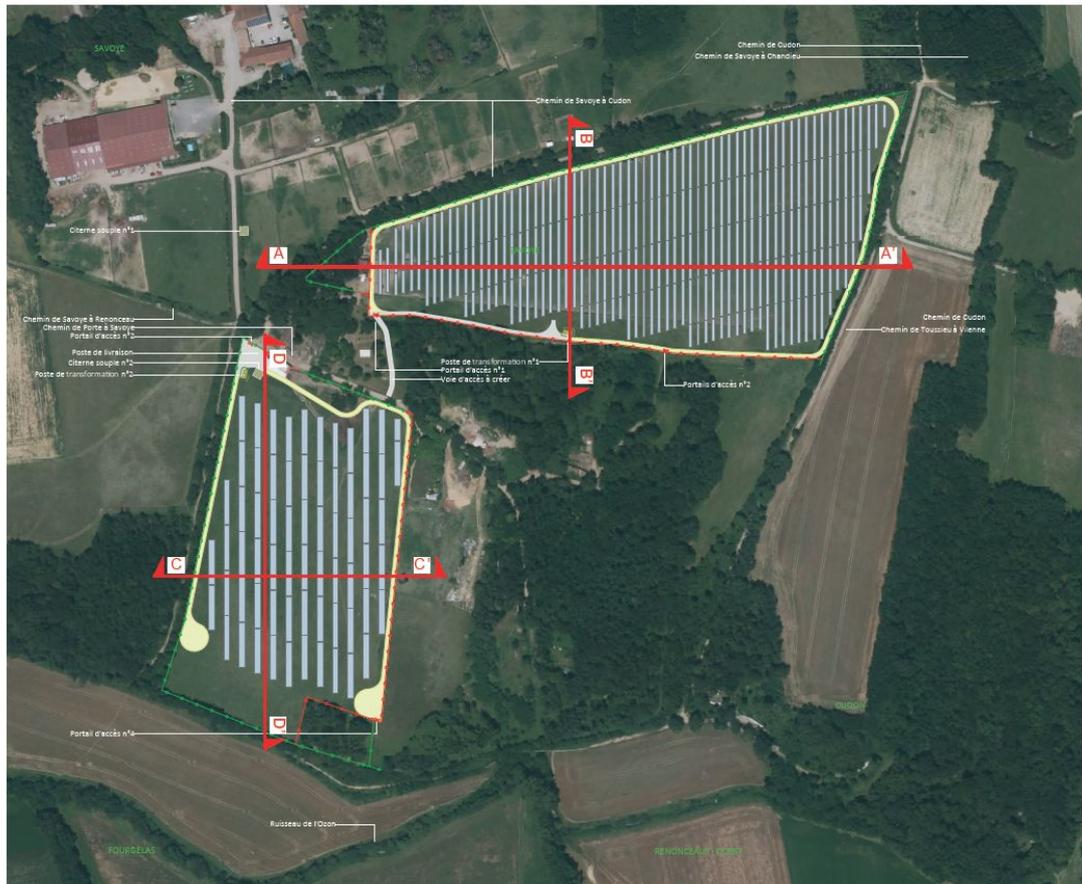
Plan des installations (source : PC3 - plans en coupe du terrain et de la construction).
